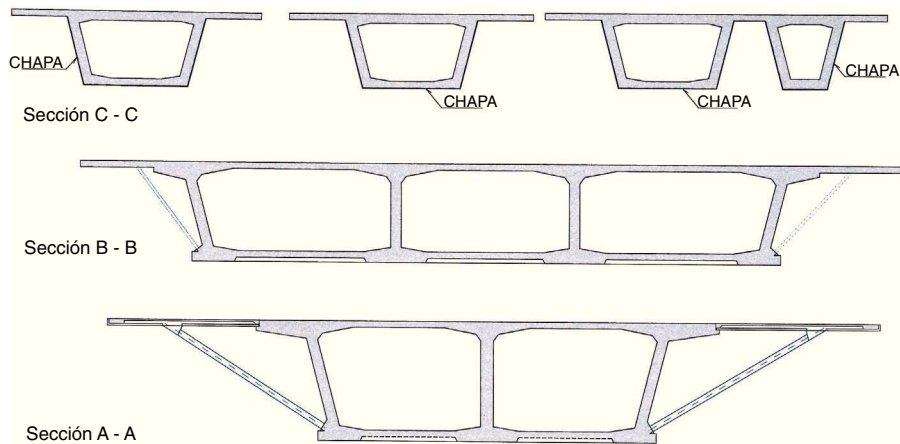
Viaducto zona de transición. Secciones fundamentales.
